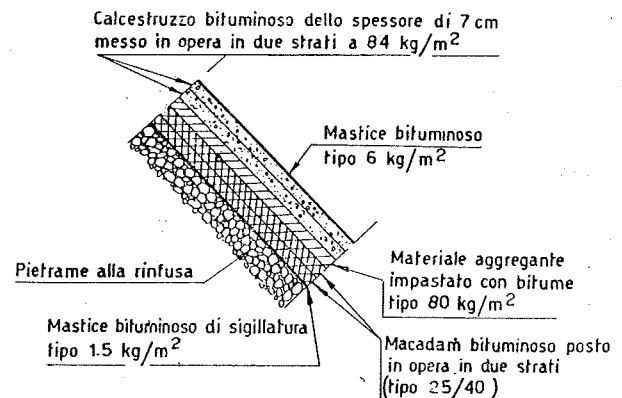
Sezione del rivestimento impermeabile sul rilevato.
